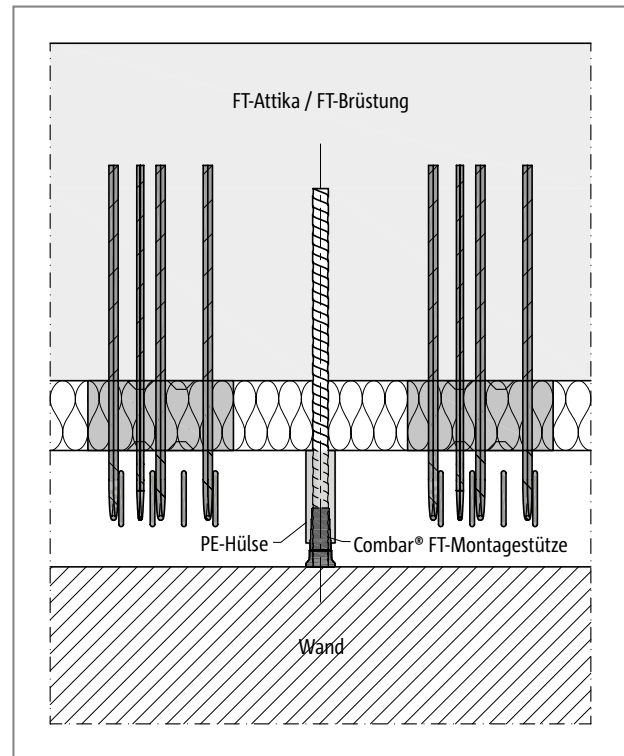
Schöck Combar® FT-Montagesätze: Einbau einer Fertigteilattika; Ansicht
